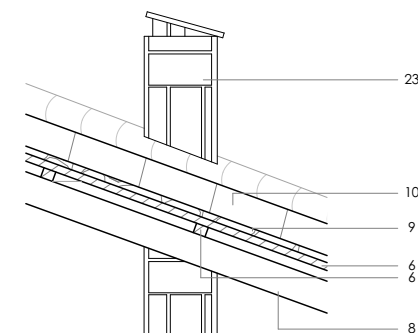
Detalle Constructivo 05. ESC 1:50
